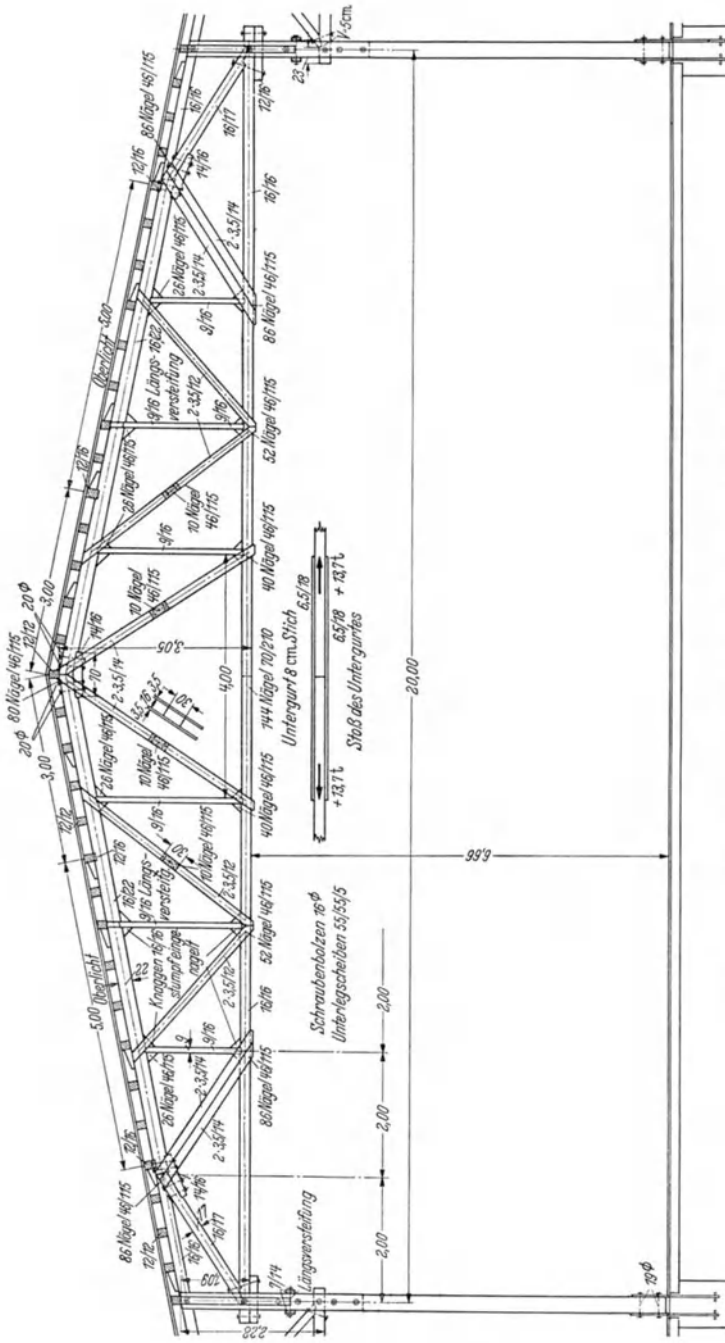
Messhalle 4 in Leipzig. Binderkonstruktion des Mittelschiffs.
